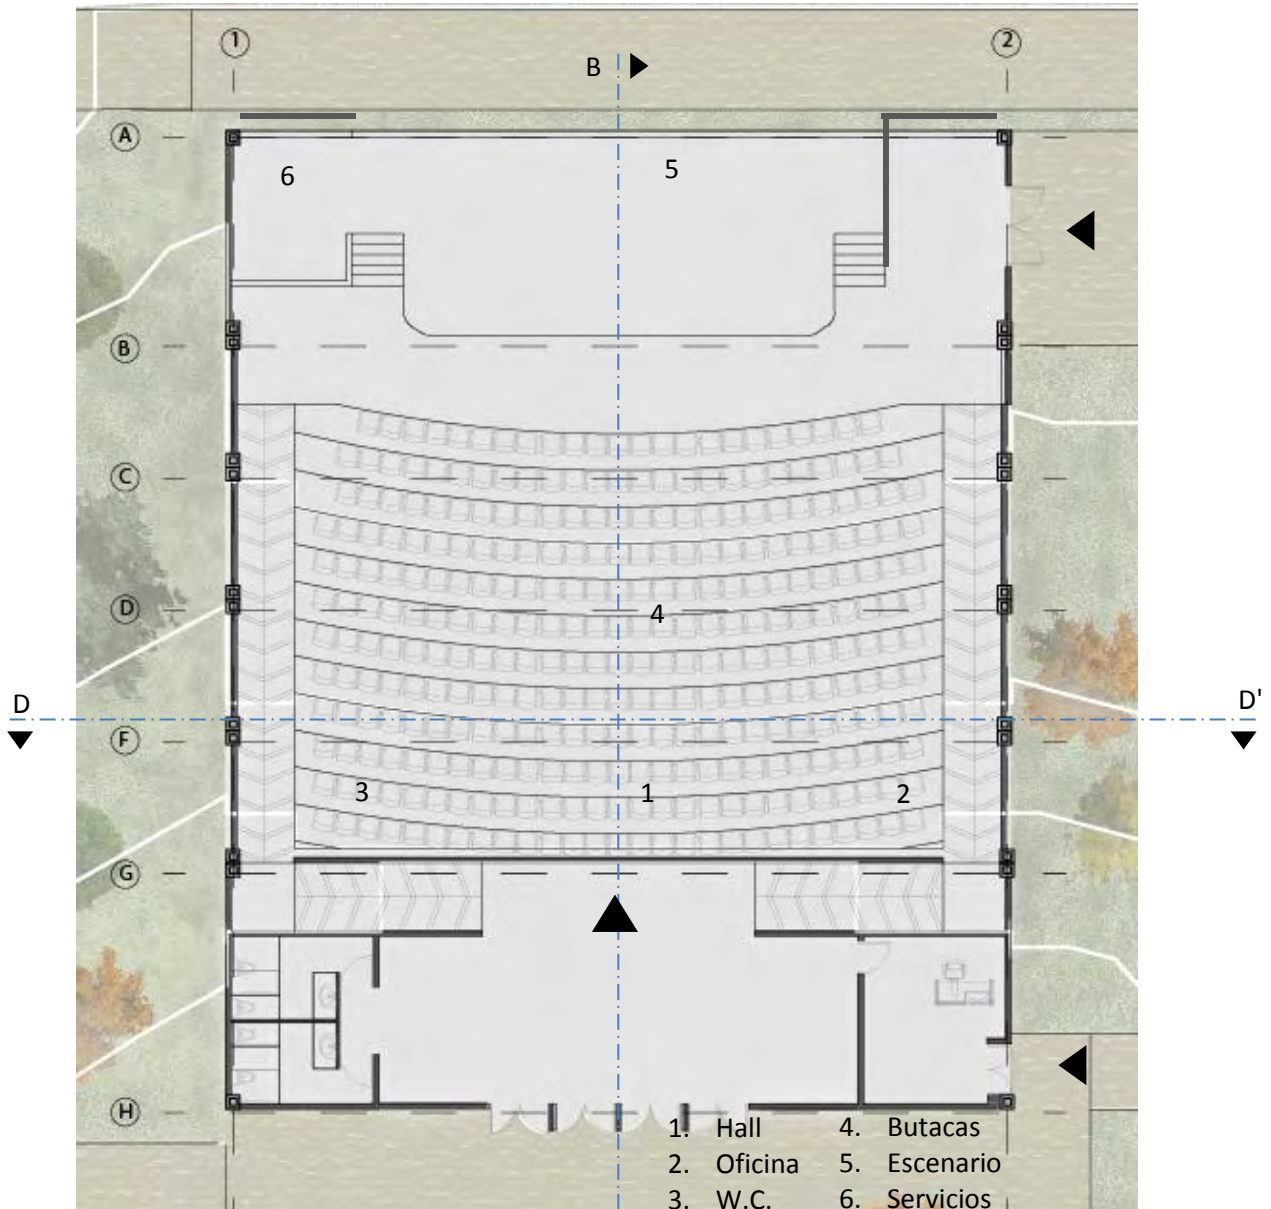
Planta Auditorio – Fuente: Elaboración Propia
